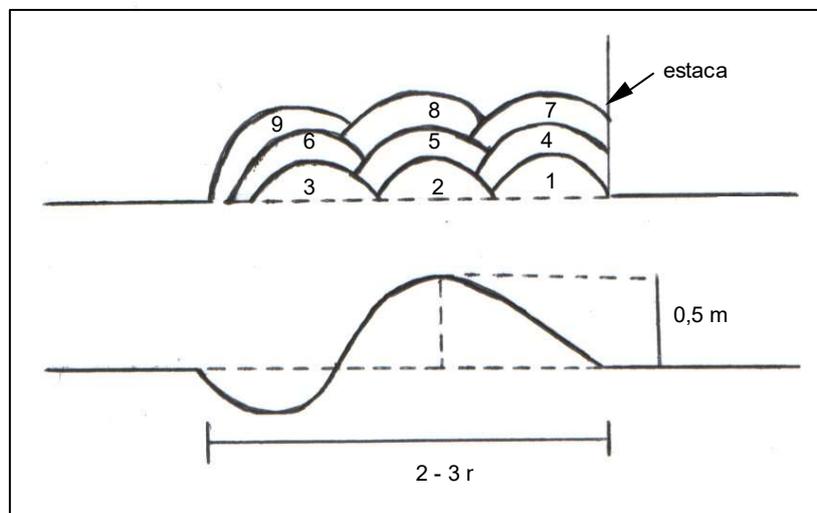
Esquema construtivo dos terraços tipo Nichols
